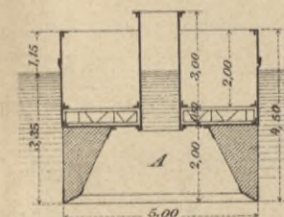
Im unteren Caisson wird Erde ausgehoben, im oberen gemauert.
